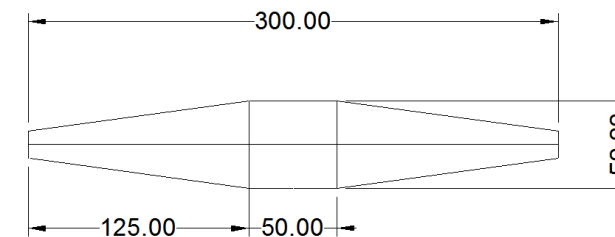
EXEMPLE DE CARACTERISTIQUES D'UNE GARE DE PEEGE, VUE EN PLAN EN METRES
